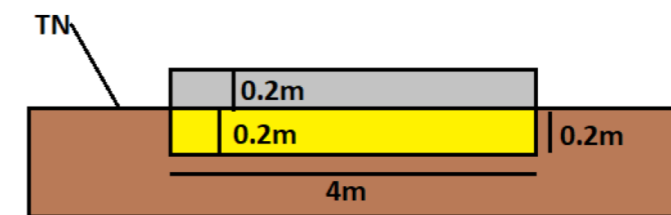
Coupe type voirie piste lourde (Source : Photosol)
